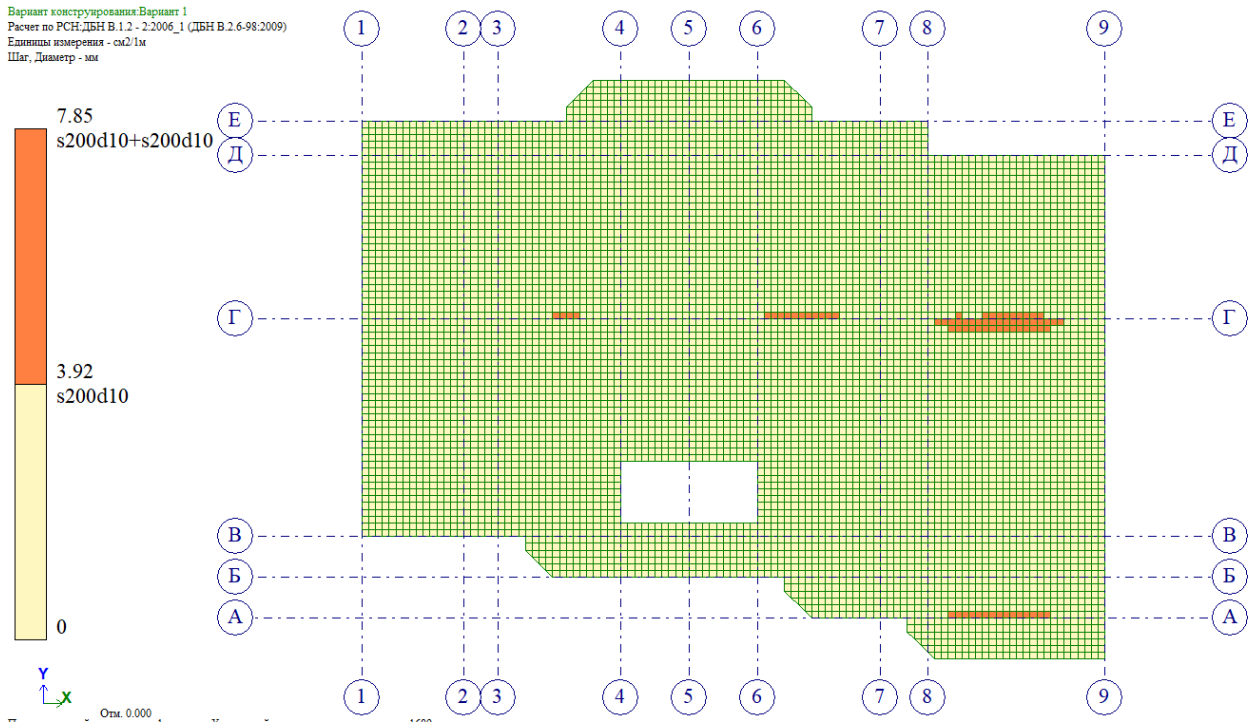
Армування плити перекриття по верхній грані вздовж осі Y
